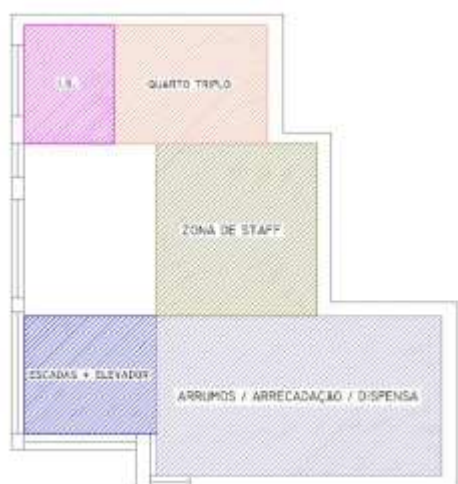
Proposta de zonamentos para o piso 2 e respetiva planta de circulação (planta original no Volume II).
